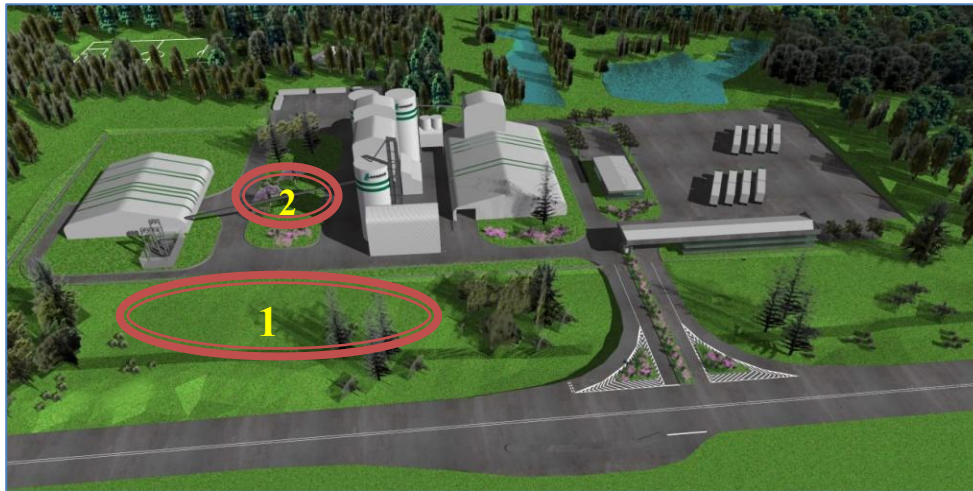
Infraestructura de la Planta Puerto Montt. En círculos las Zonas 1 y 2.
